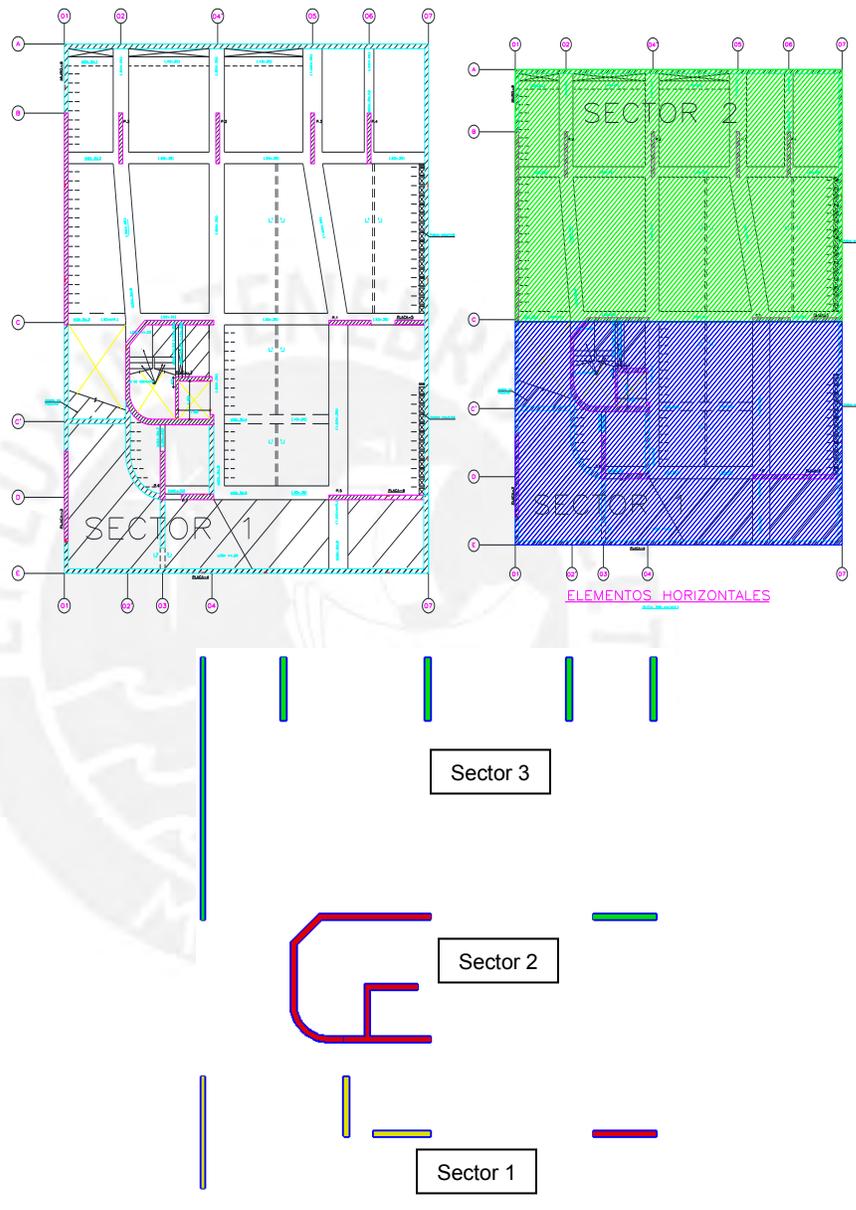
Planta típica y sectorización de elementos horizontales y verticales.
